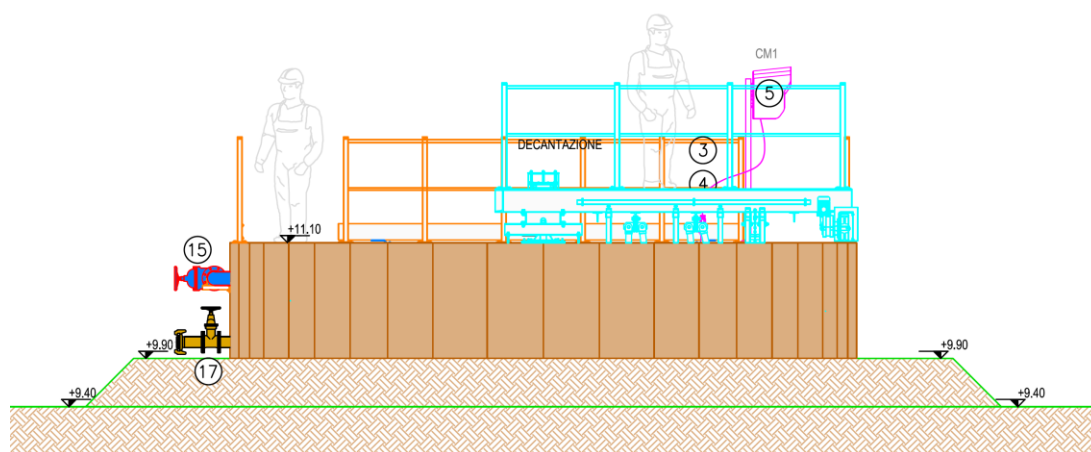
Prospetto sud-ovest del nuovo impianto di depurazione
